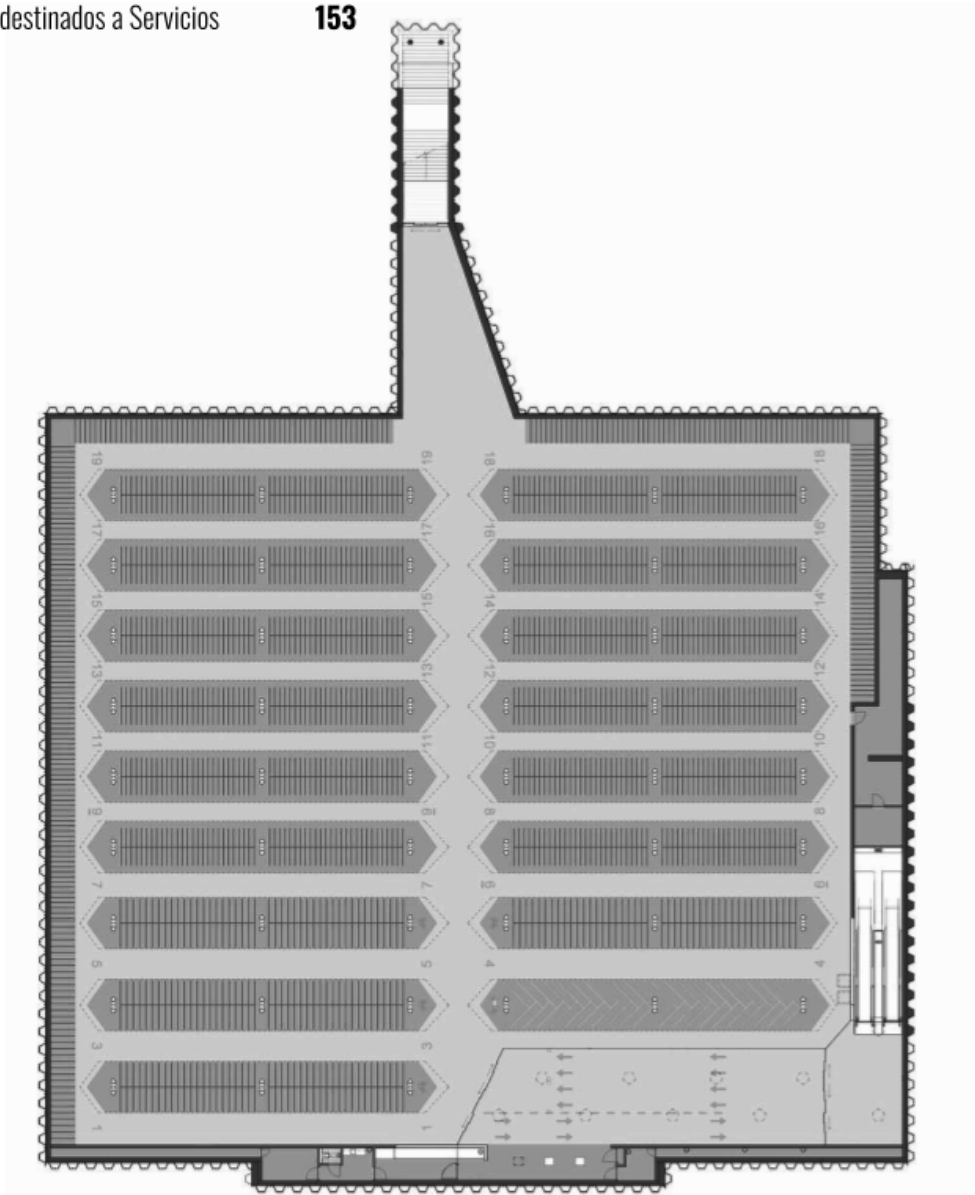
Plano arquitectónico de bicicletas en estación Strawinskylaa, wUrck.
